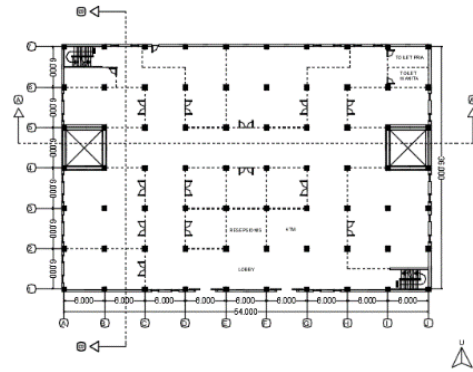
dan Gambar 3 adalah tampak gedung apartemen. Gambar 4 dan Gambar 5 adalah denah lantai gedung apartemen.
